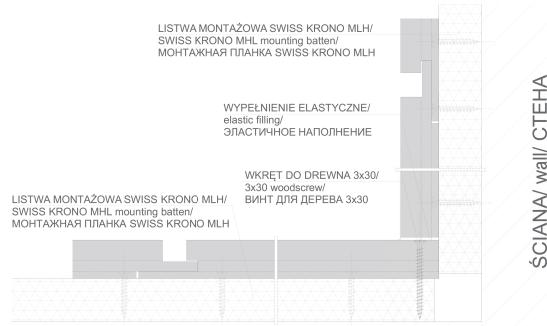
Docięcie elementów brzegowych WALLDESIGN
